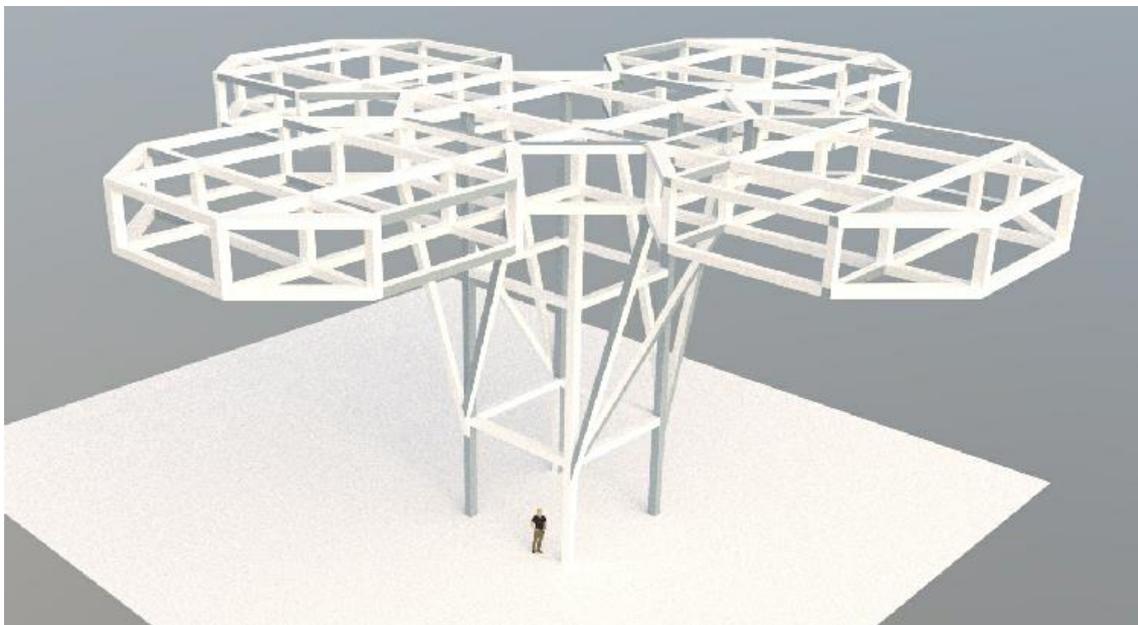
Modelado de la estructura Fractal Propuesta para el Proyecto
